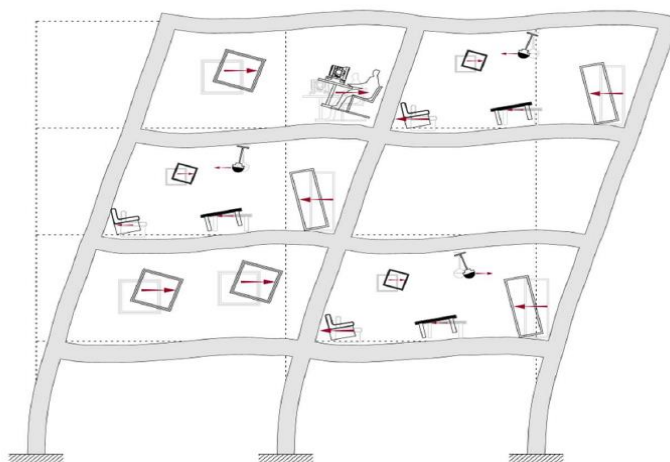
Pjesëmarrja e masave në lëvizjen e strukturës
